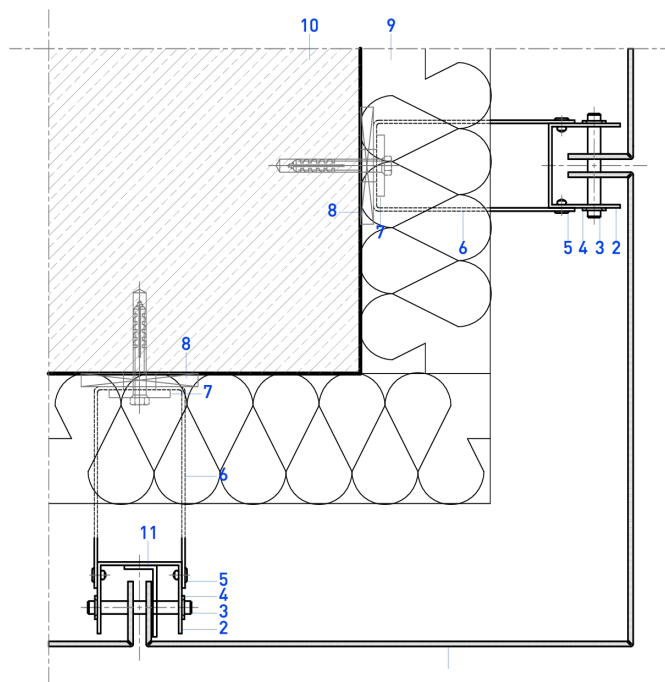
DETAIL D'ANGLE INTERIEUR (coupe horizontale)
